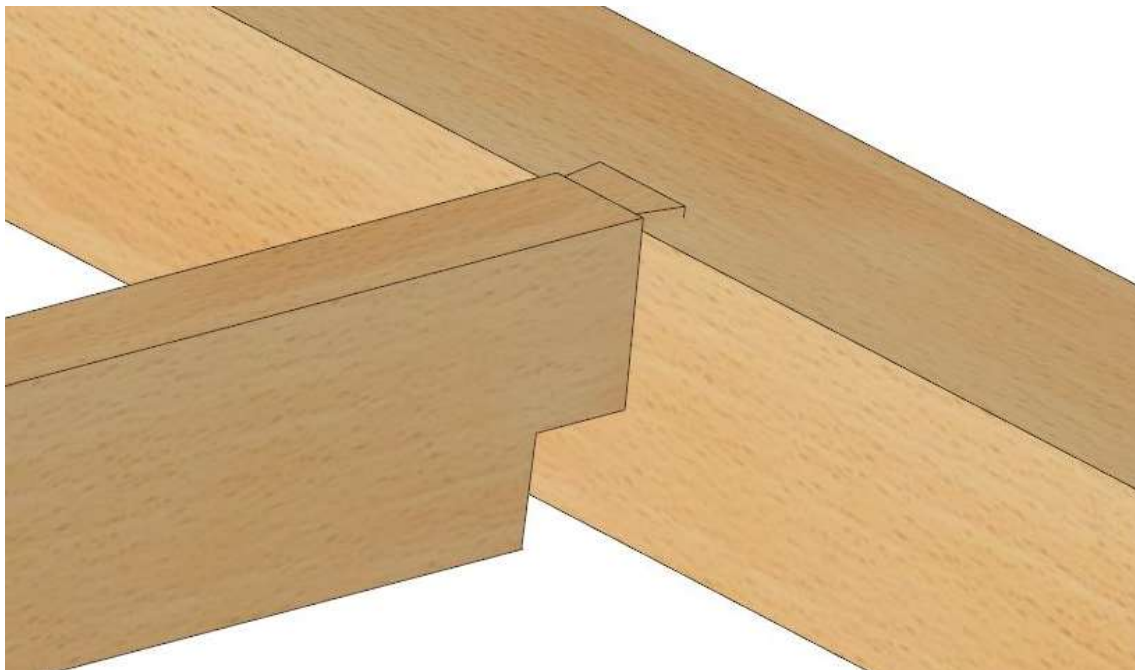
Detalle de unión entre la cuarta viga maestra y las viguetas. Imagen de Cadwork.
